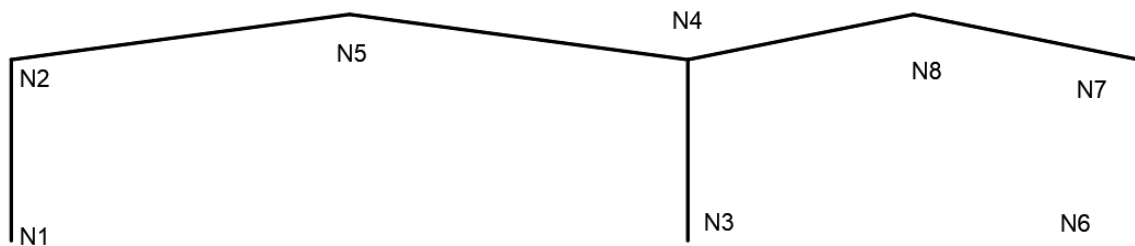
Pórtico tipo. Fuente: Creación propia.
